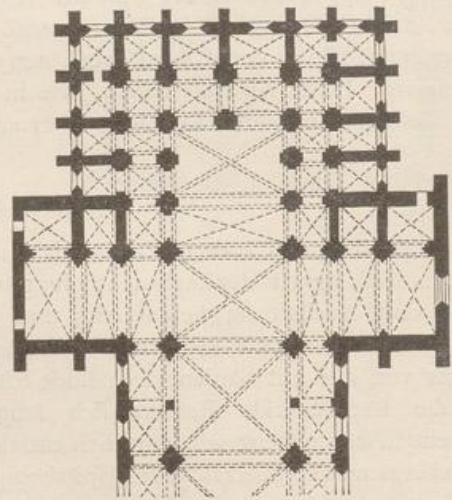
Grundriss von Ebrach. (Nach v. Quast.)
